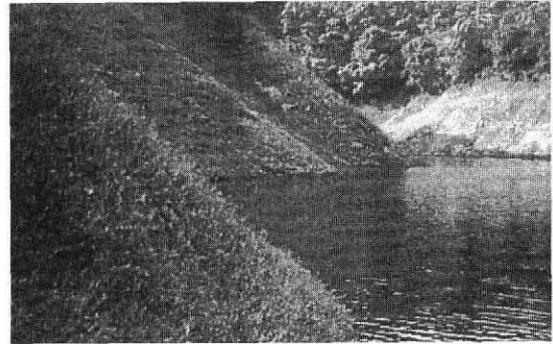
鶴田ダム 急傾斜での育成状況 (H13.9月)
